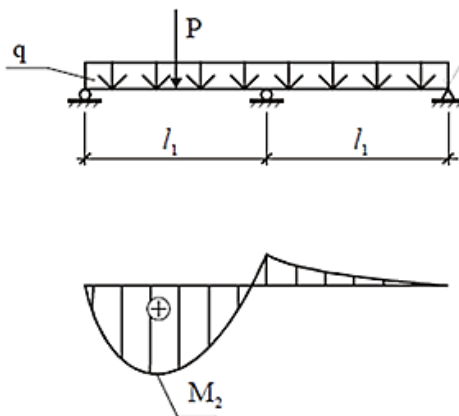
Розрахункова схема обрешітки для другого поєднання навантажень (власна вага і монтажне навантаження)
